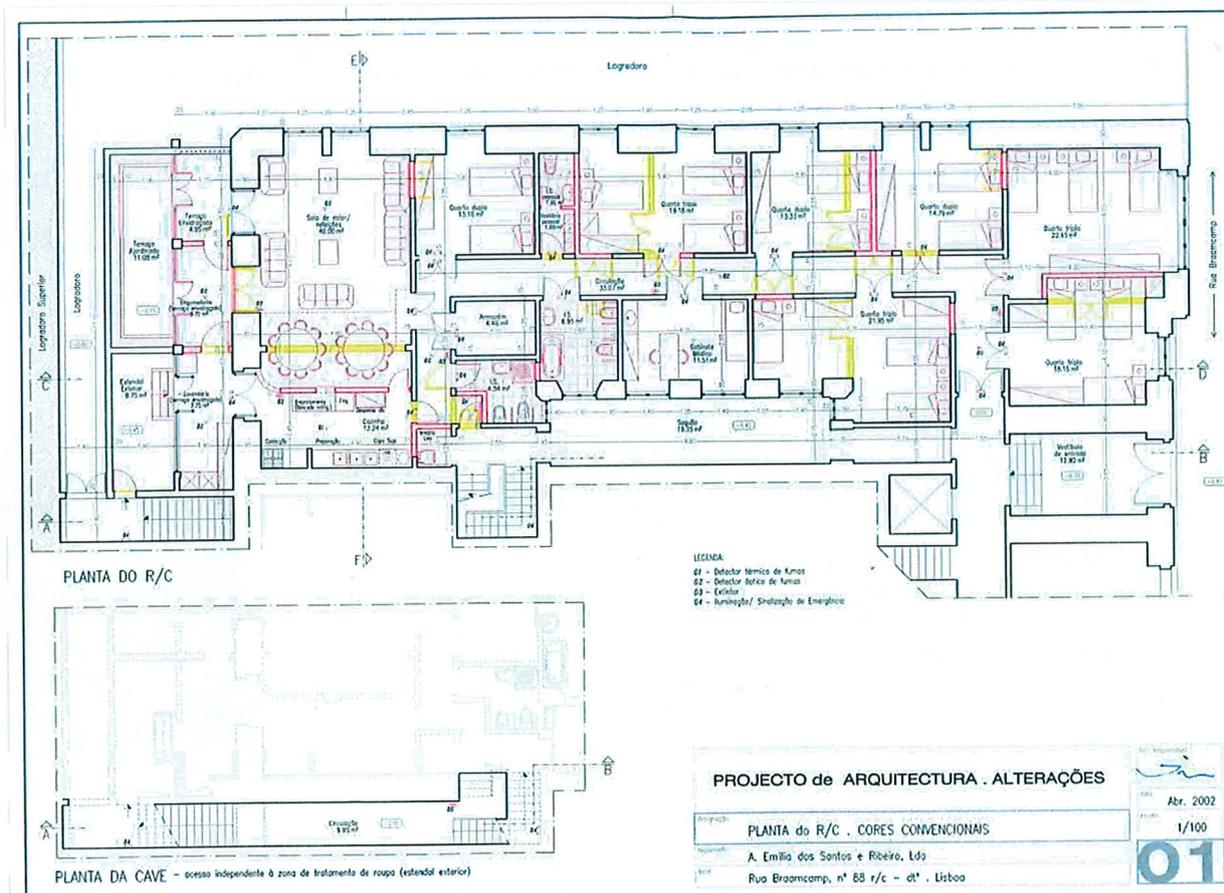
N.º 86-88, R/C – Dto. [Proc.º 2002/23-6(240) – Projeto de alteração, abril de 2002, planta. [Arqt.º José Paulo Jacinto]
